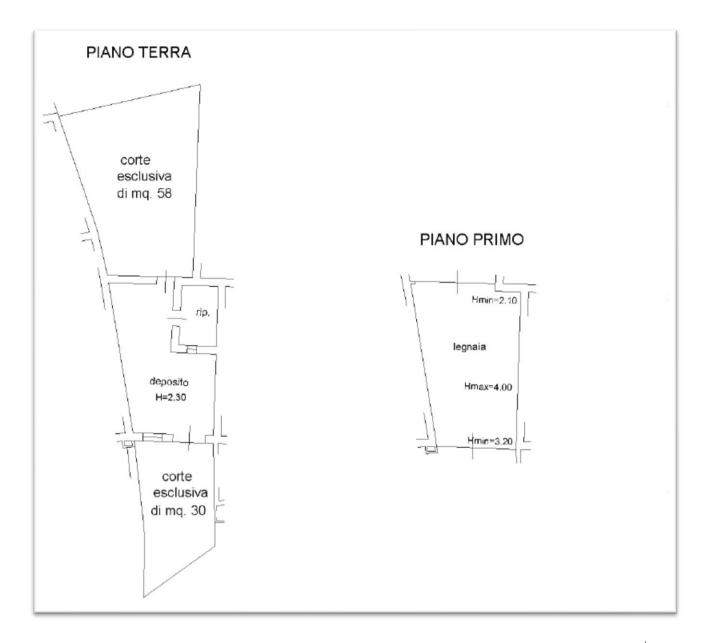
b: Planimetria catastale Mappale 185, sub 8
